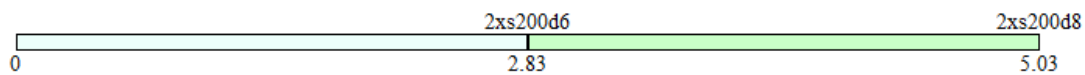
Разрез 1, арматура вдоль оси X
